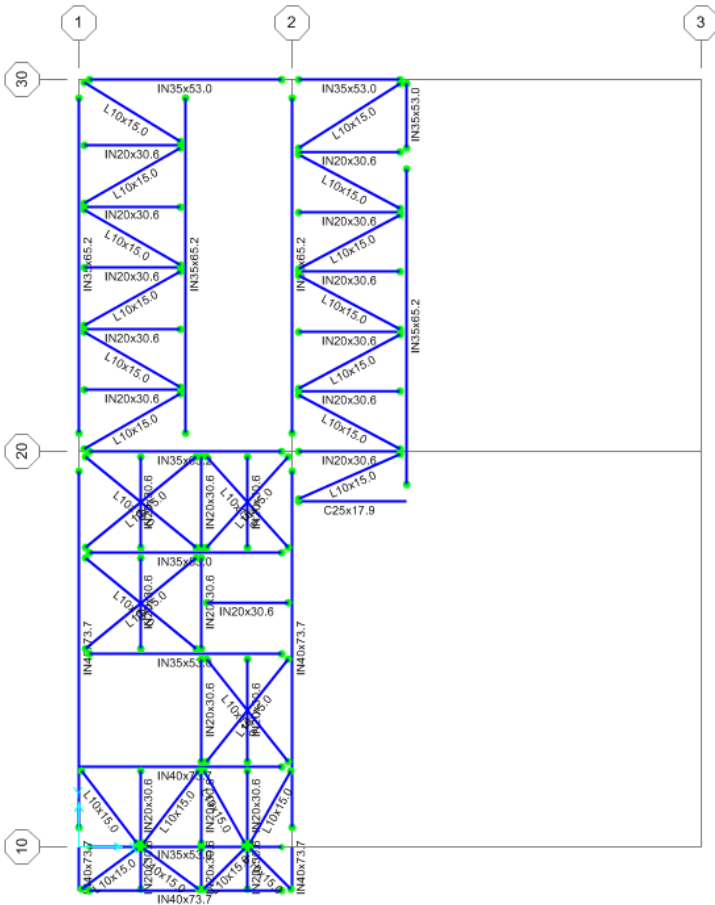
Planta Elevación 2.8 m sobre el nivel de terreno. En la figura se muestra la distancia entre ejes la cual se omite posteriormente por claridad.
